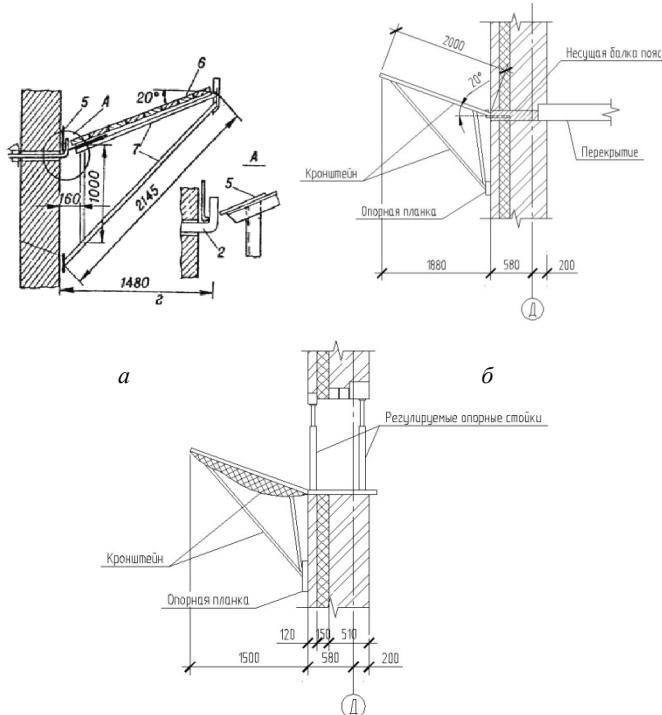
Схема устройства защитных козырьков по периметру здания (ТТК «Кирпичная кладка наружных стен и внутренних перегородок с монтажом перемычек»): *а* – сквозное крепление козырька к стенам сплошной кладки (вариант исключается для выполнения трехслойной кладки с утеплителем внутри стены); *б* – крепление козырька (при выполнении трехслойной кладки с утеплителем внутри) к несущей балке-поясу, предназначенному для опирания лицевого слоя кирпича; *в* – крепление козырька в оконных проемах здания с применением регулировочных опорных стоек (схемы *а* и *б* выполнены студенткой П.С. Поповой, гр. ПГС-13-26)
